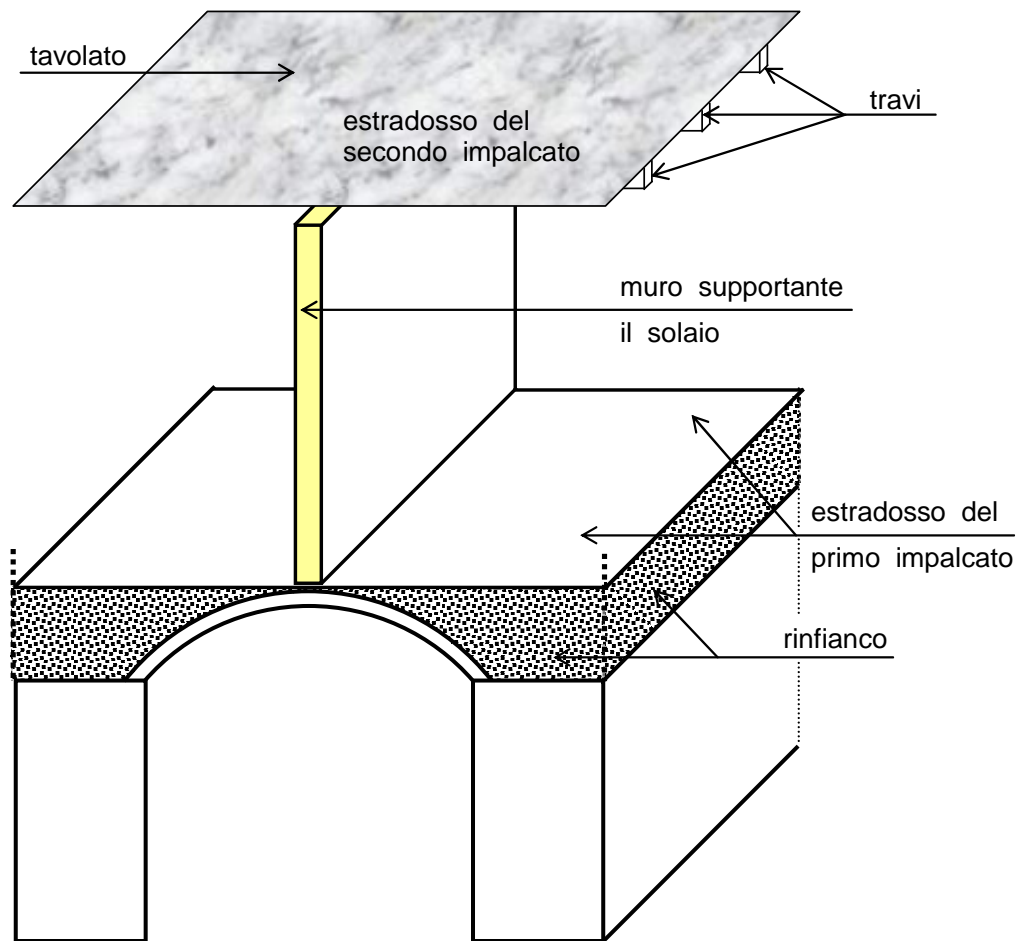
e. Il secondo impalcato è sempre portato da un muro ortogonale alle travi del solaio, poggiato sull'estradosso del primo impalcato. In questo caso, come in figura *a*, il muro è ordito parallelamente alle generatrici della volta; ossia il muro porta-solaio è ortogonale alle direttrici. Rispetto al caso *a/b*, dunque, l'orditura è la medesima, ma il solaio è portato da un solo muro, fondato in chiave della volta.
